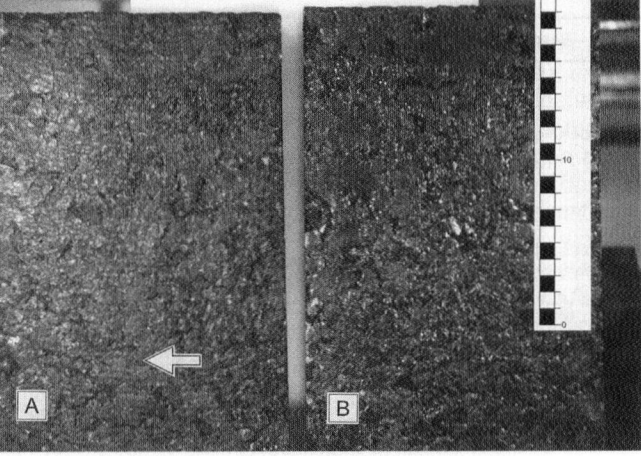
Vergleich einer unbearbeiteten Asphaltplatte (B) mit einer Platte, die geblämt wurde (A)
